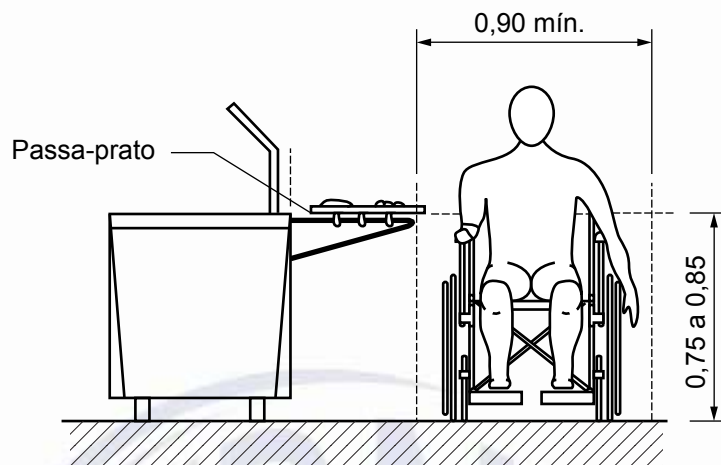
Refeitórios – Medidas e espaço para circulação – Vista frontal
